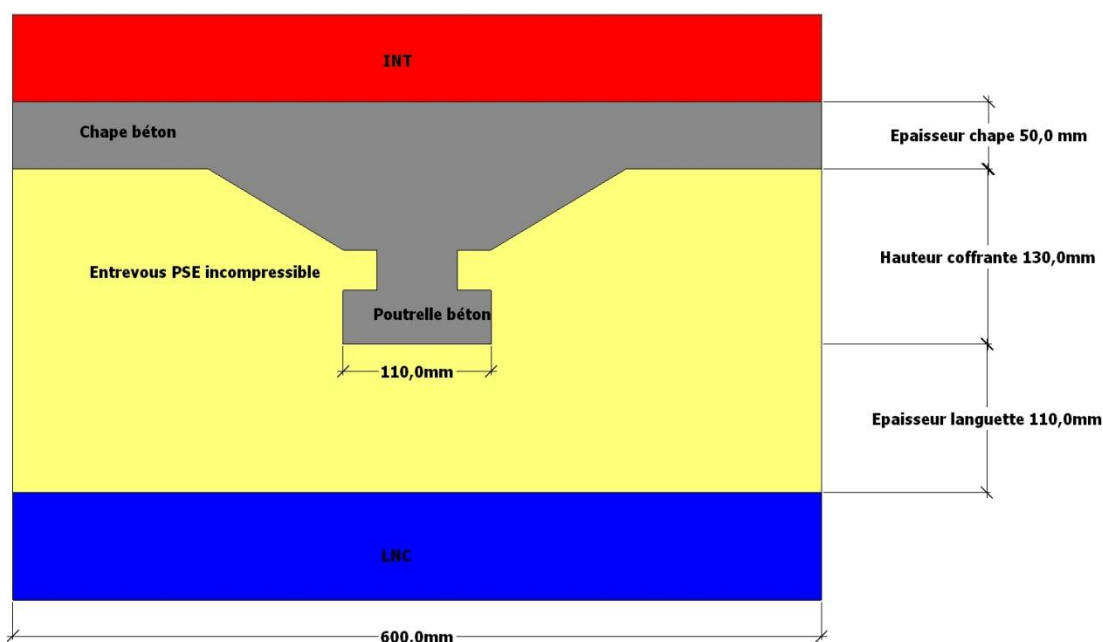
Plancher bas avec entrevous isolant sur vide-sanitaire
